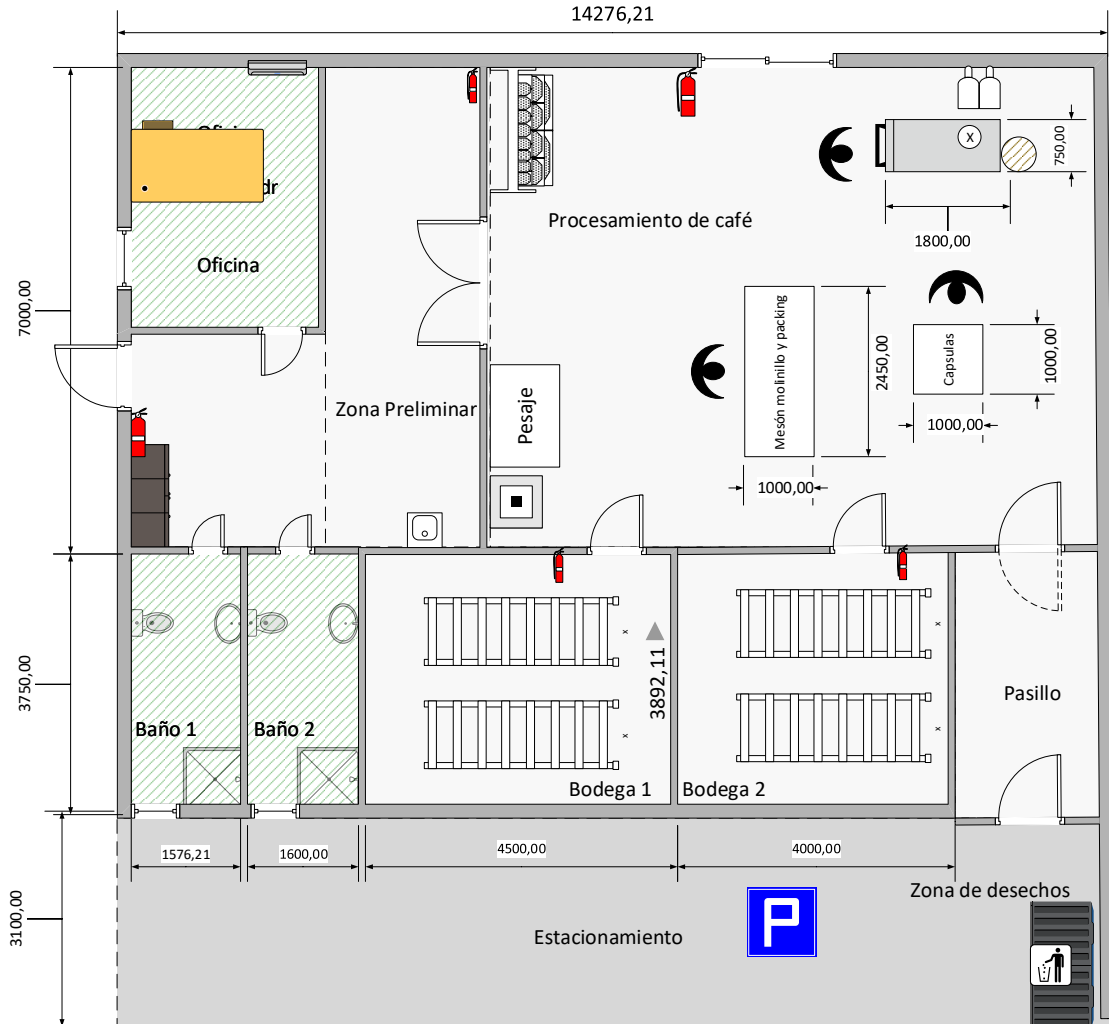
Plano de planta con proyecto. Elaboración propia.
